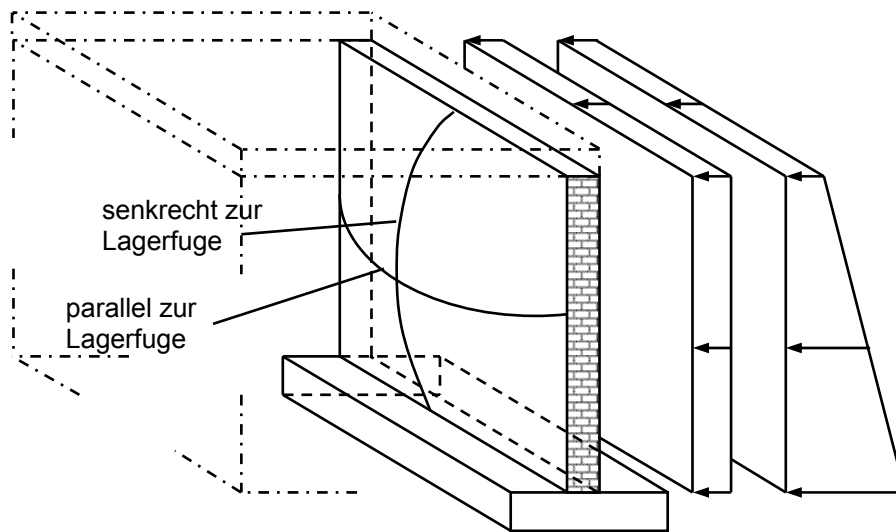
Mauerwerk unter Biegebeanspruchung senkrecht und parallel zur Lagerfuge
